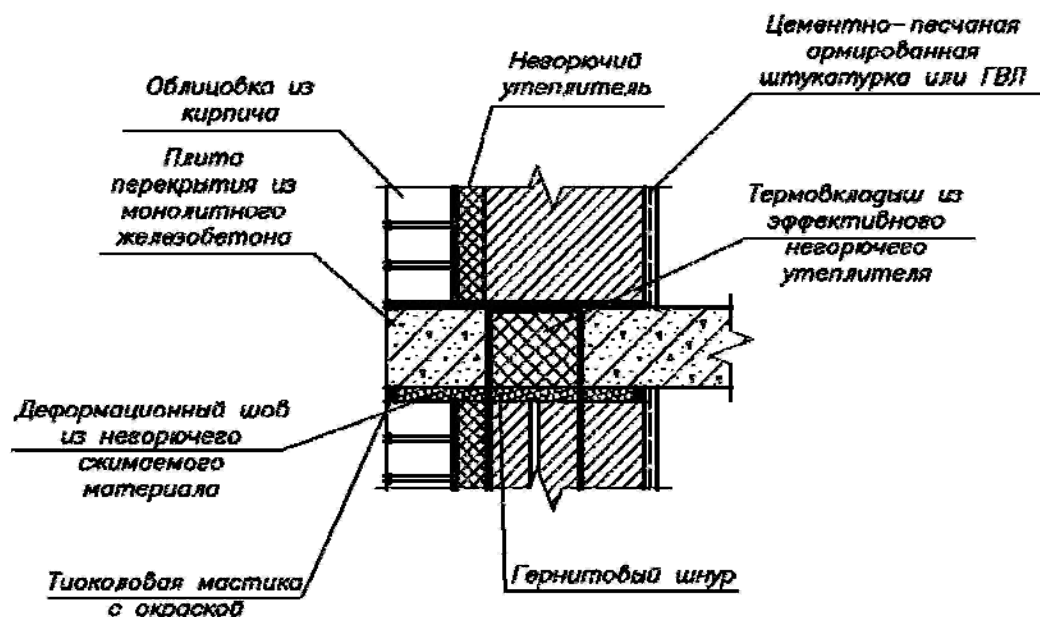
Вариант узла опирания на перекрытия фасадной кирпичной кладки (облицовочная кирпичная стена, опирающаяся на консольные монолитные свесы перекрытий)
